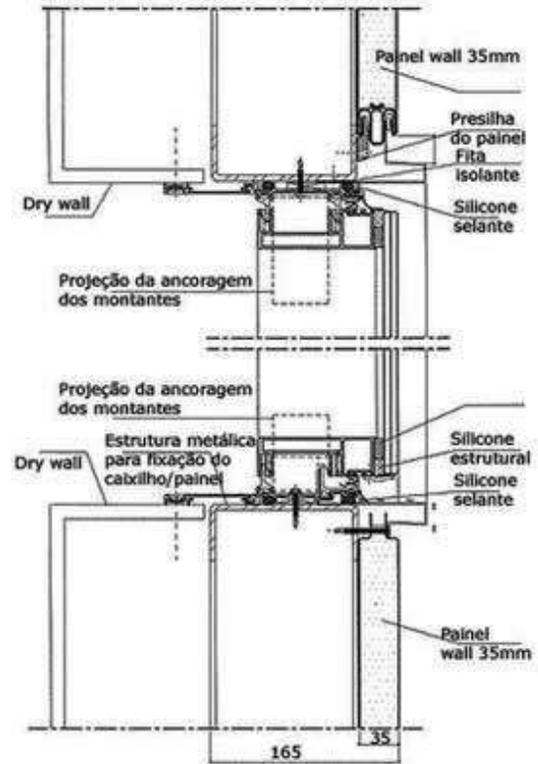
Detalhe em corte de abertura para esquadria em fachada com painel metálico isolante. (FINESTRA, 2004)
